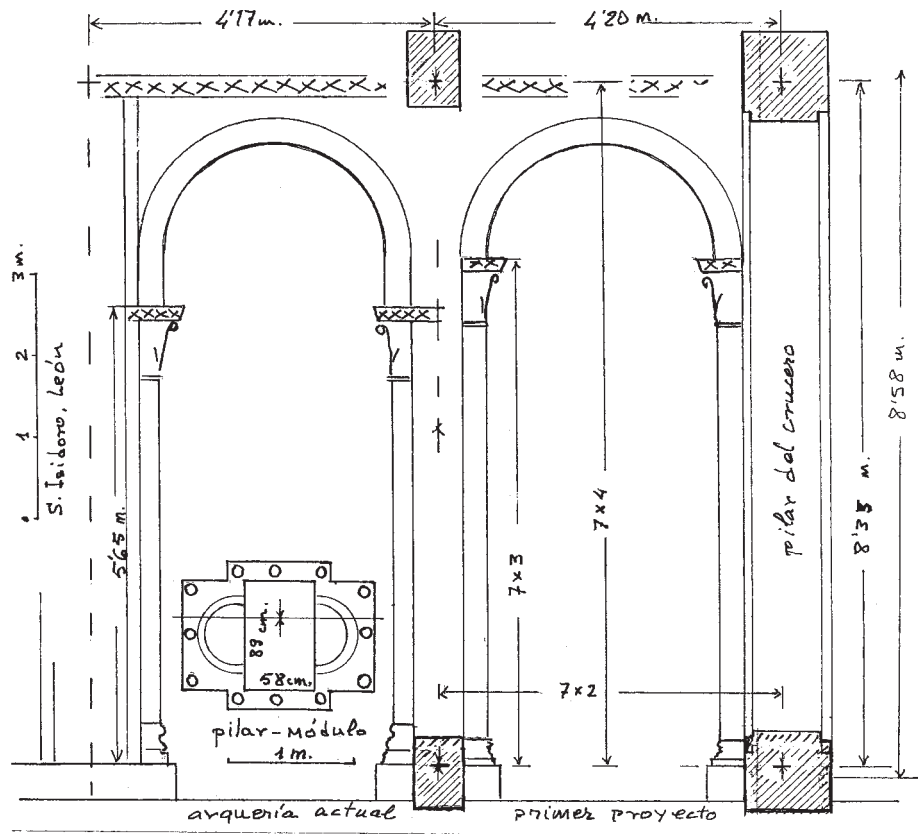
Superposición del alzado sobre la planta de la nave central.
